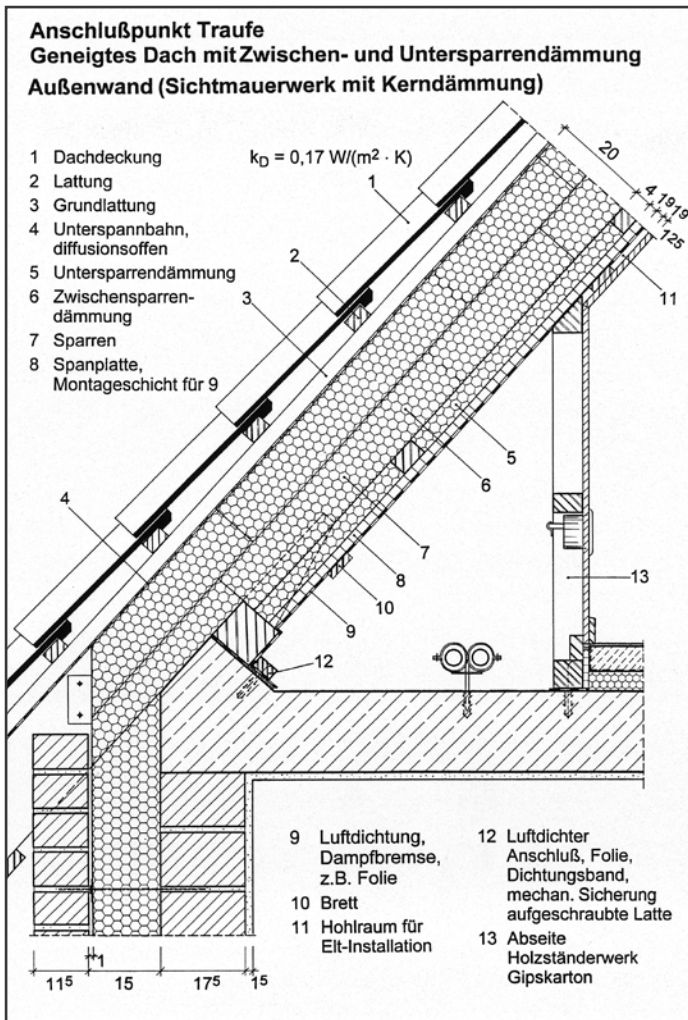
Geneigtes Dach (Kehlbalken- bzw. Sparrendach) mit Zwischen- und Untersparrendämmung, Anschluss an die Außenwand. Führung der luftdichten Schicht (Folie auf Holzwerkstoffplatte) hinter der abseitenwand bis auf die Stahlbetondecke, Lit. 07.
